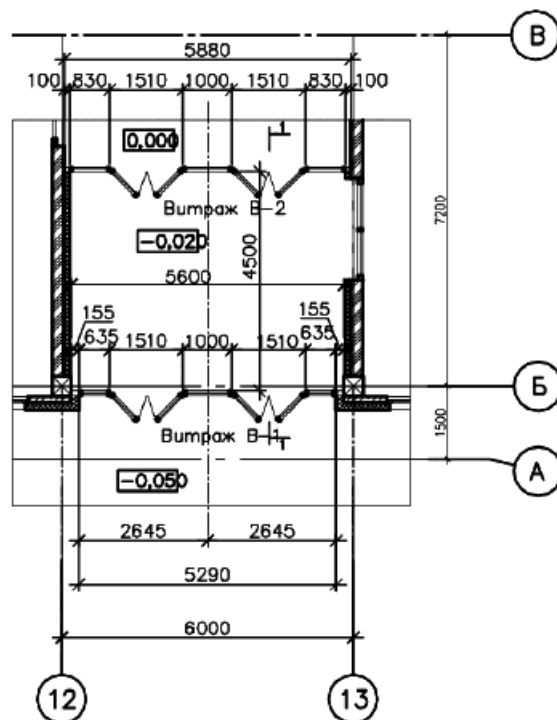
Фрагмент плана 1-го этажа. План тамбура главного входа
